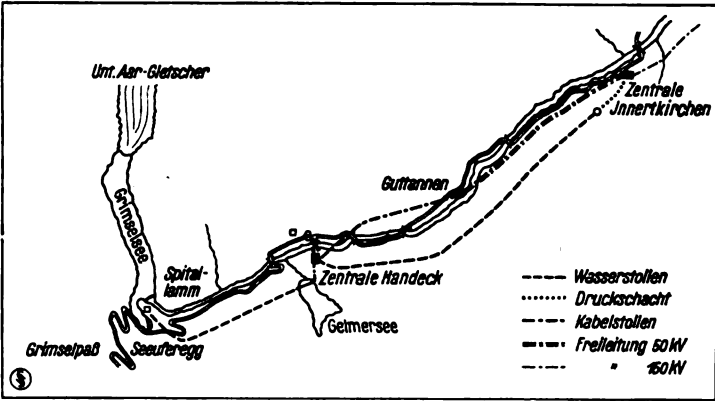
b. Lageplan der Kraftwerke im Oberhasli-Tal.
